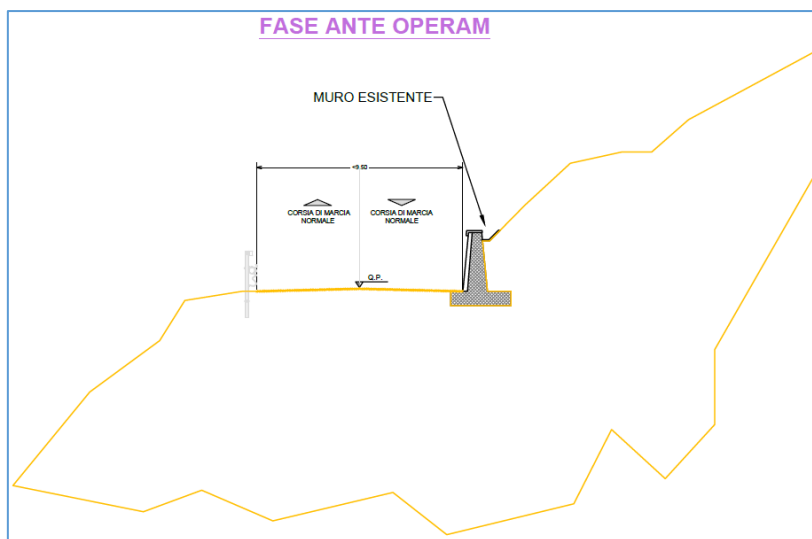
a – Sezione tipo 5 – Ante Operam
